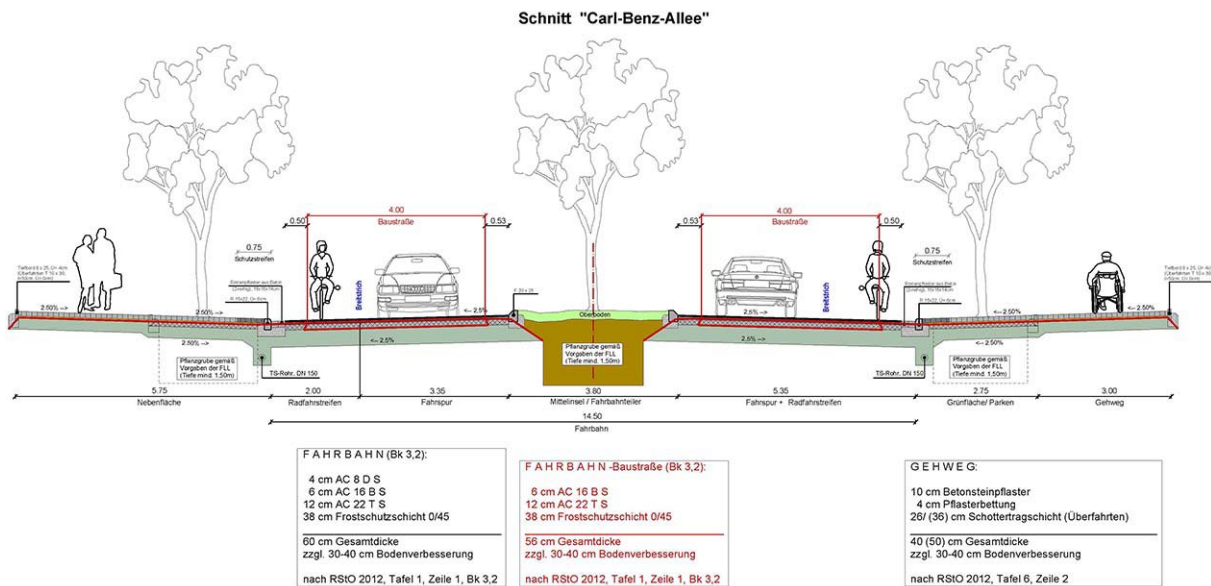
Straßenquerschnitt der Carl-Benz-Allee (Quelle: IMB Plan, Hanau)
